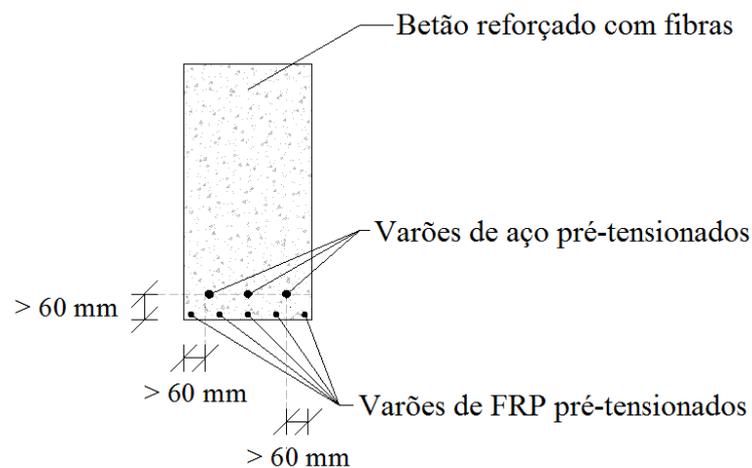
Conceito de reforço híbrido para vigas e lajes pré-fabricadas em FRC.
